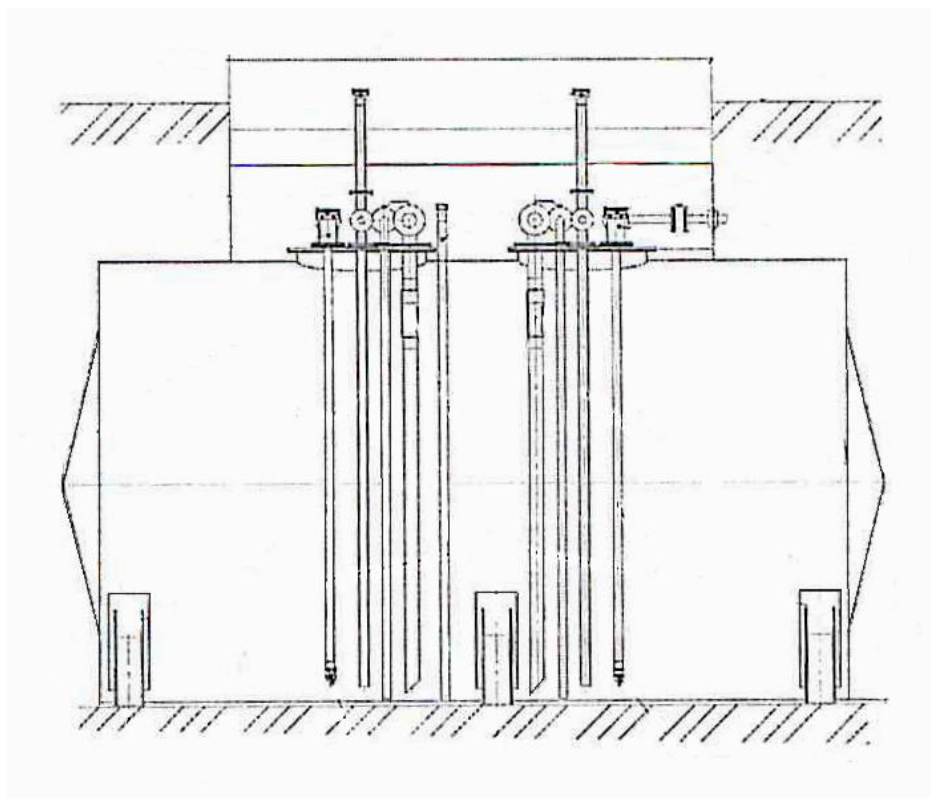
Эскиз резервуаров РГСД-25 №№ 604, 605, 610, 611
